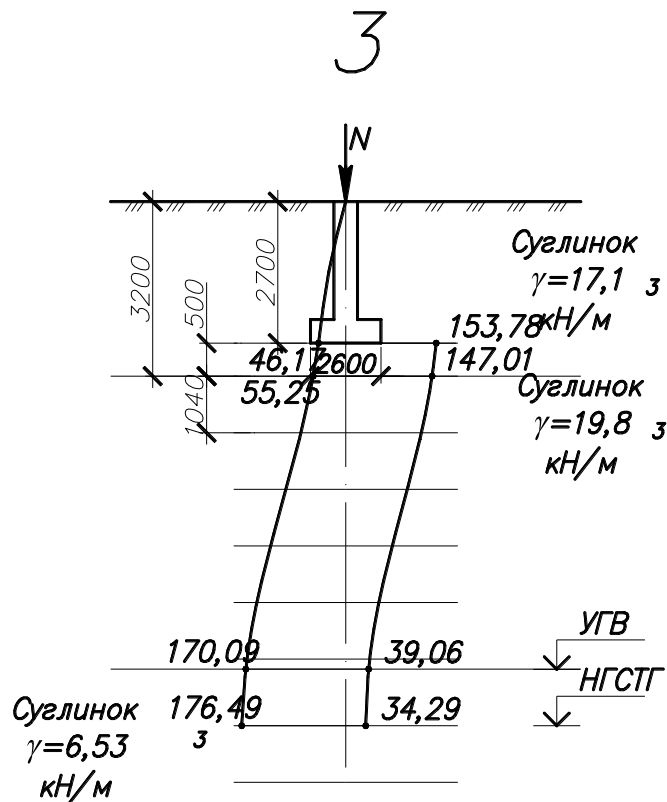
Осадка фундамента в сечении 3-3
